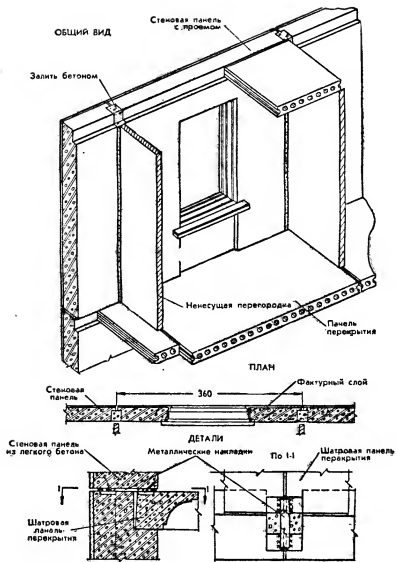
Конструкции бескаркасного крупнопанельного здания.
